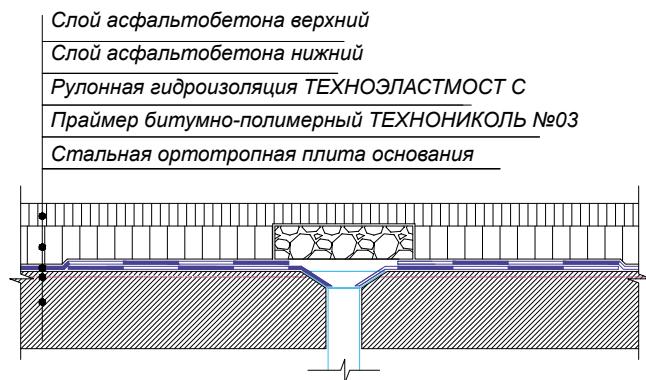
Сопряжение гидроизоляции с дренажной трубкой.
